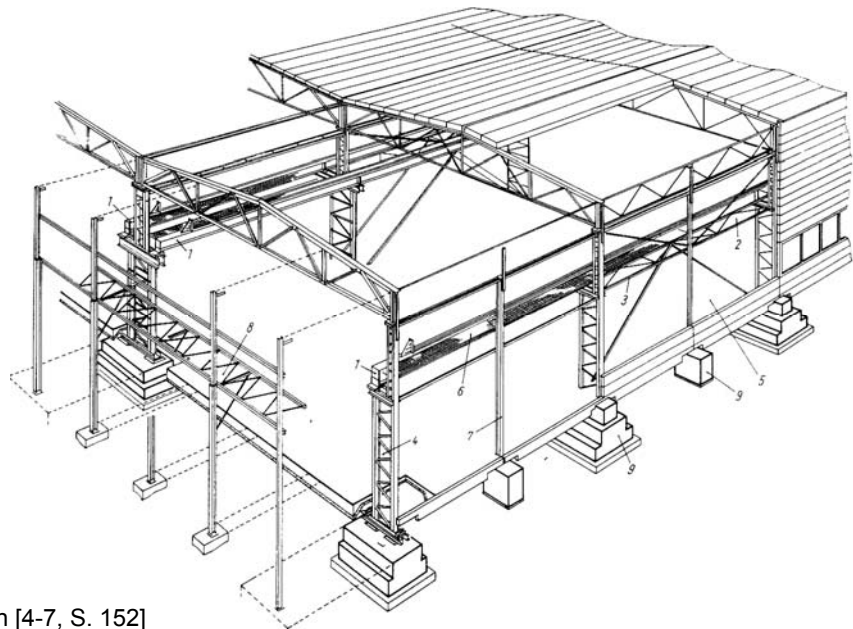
Stahlhalle mit Kranbahn [4-7, S. 152]
